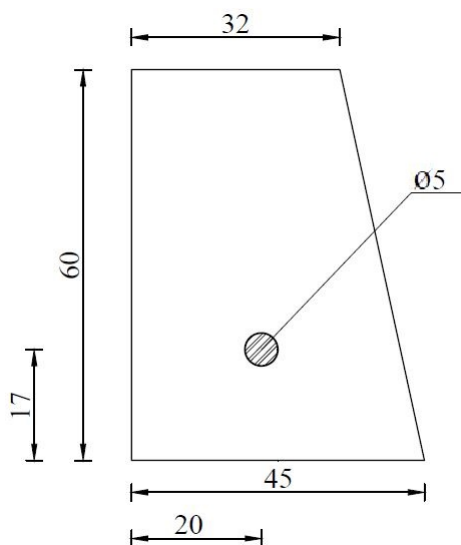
Geometria da secção das vigas ensaiadas, em mm.
